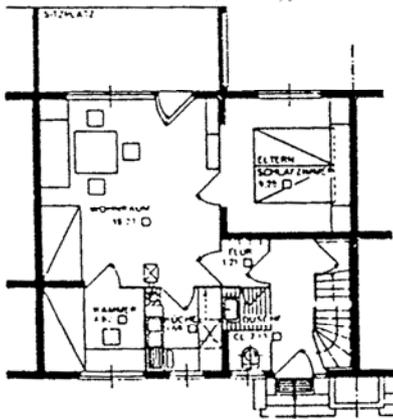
Grundrisstypologie der Zweifamilien – Kleinsthäuser
